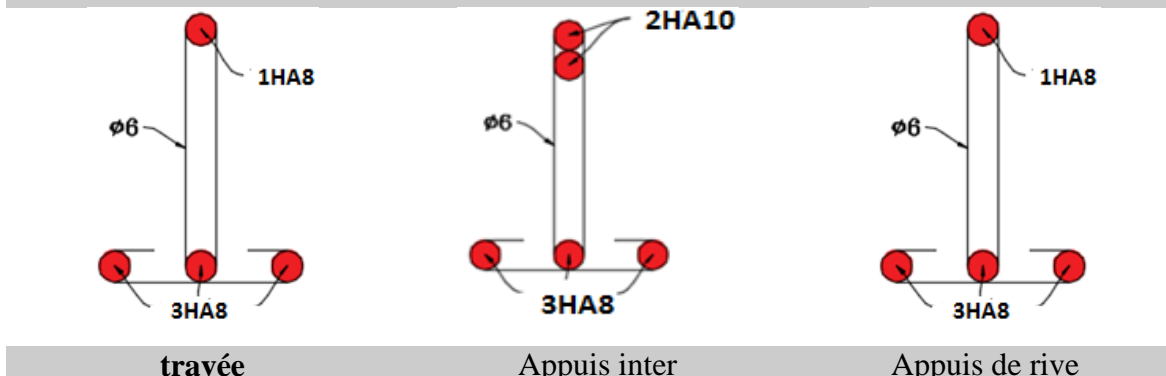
Schémas de ferrailage des poutrelles du RDC
